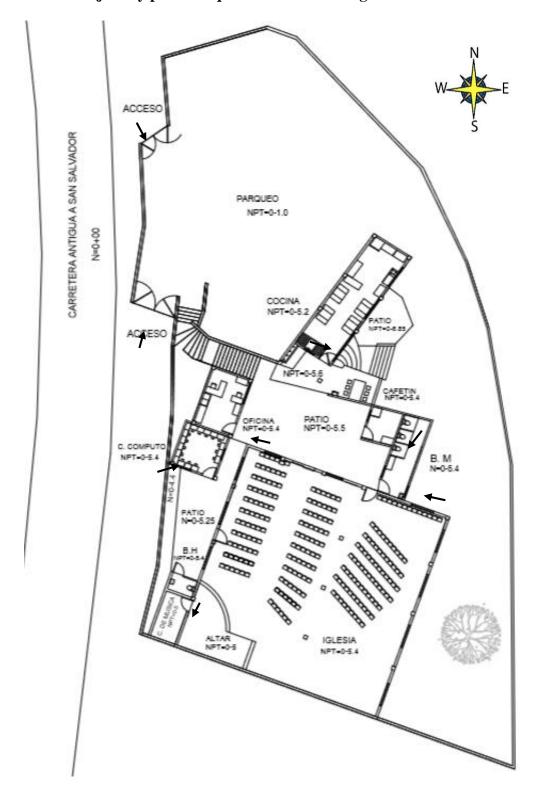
Plano de conjunto y planta arquitectónica media segundo nivel. Elaboración propia.
